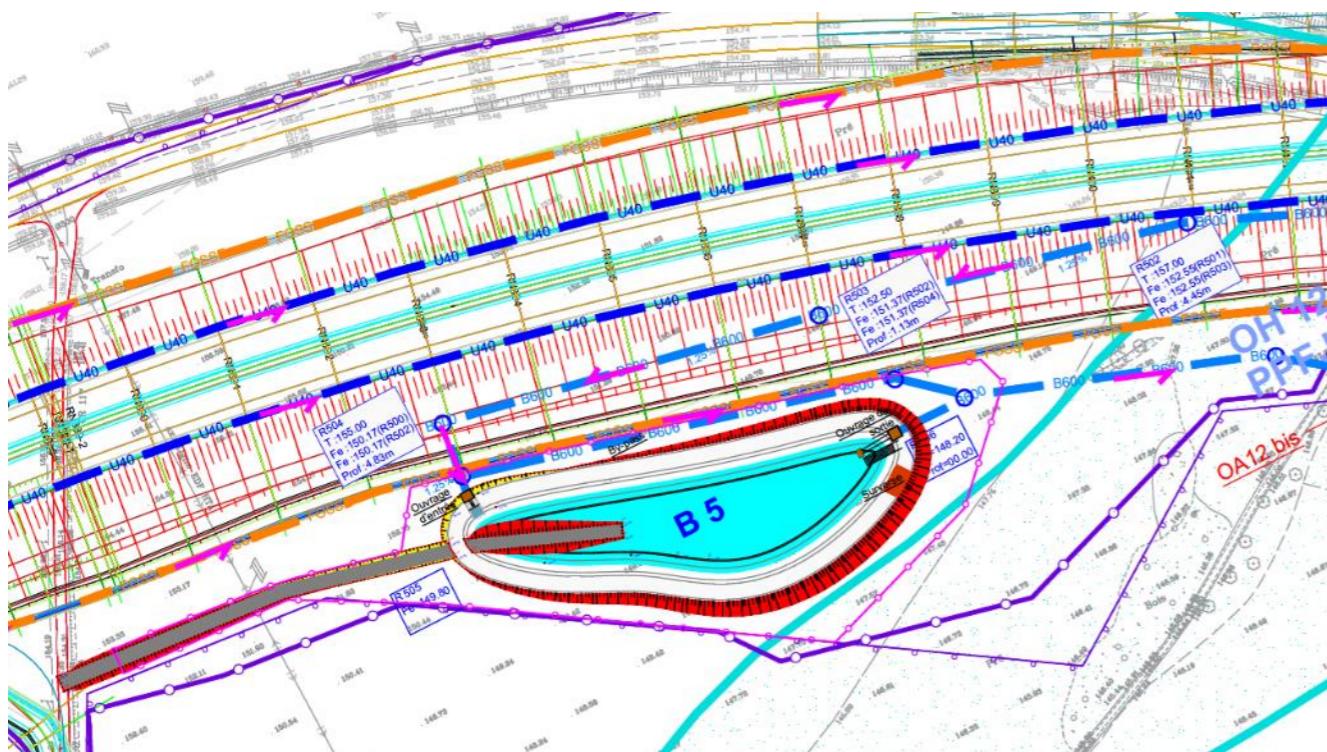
Plan d'assainissement du BR5 (source : SIR)
